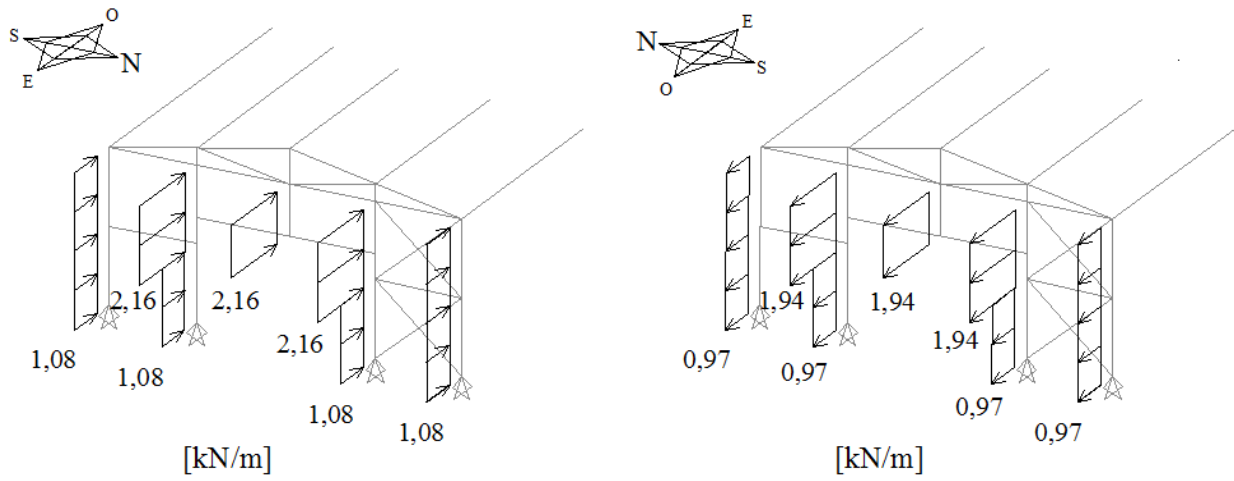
Vento W2 nas fachadas orientadas a Este e Oeste na situação 1 (RSA)
